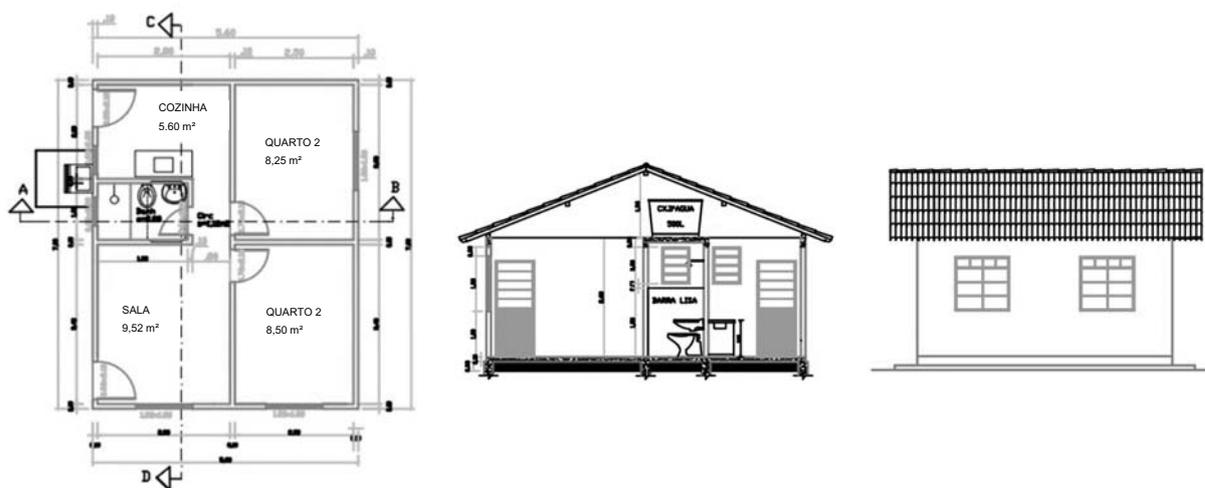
Planta baixa, corte e fachada de residência de interesse social.
